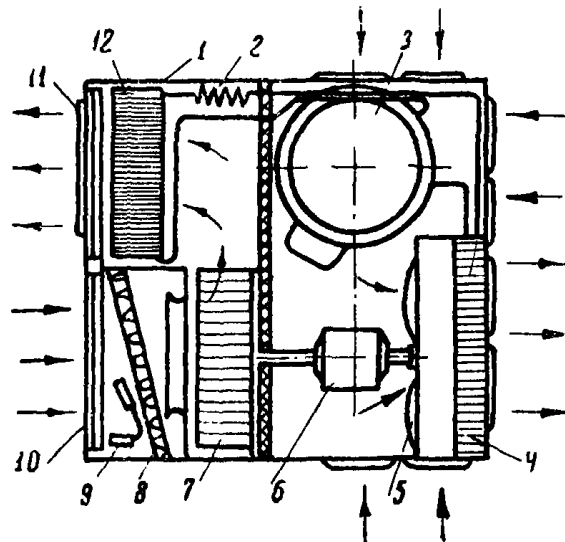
Кондиціонер з повітряним охолодженням: 1 - корпус; 2 - капілярна трубка; 3 - фреоновий компресор; 4 - повітряний конденсатор; 5 - осьовий вентилятор конденсатора; 6 - електродвигун вентилятора; 7 - відцентровий вентилятор випарника; 8 - фільтр; 9 - терморегулятор повітря; 10 - повітрозабірні ґрати; 11 - припливні ґрати; 12 - пластинчатий теплообмінник
